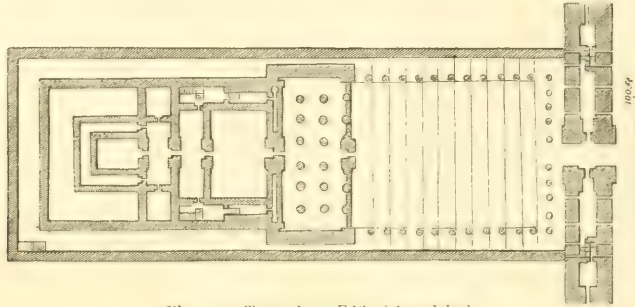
Tempel zu Edfu (Grundriss).
